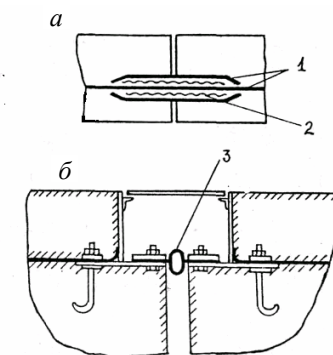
Гидроизоляция швов: а – шов с малым раскрытием; б – шов с большим раскрытием; 1 – слои гидроизоляции; 2 – металлическая лента; 3 – резиновый компенсатор (шпонка)
